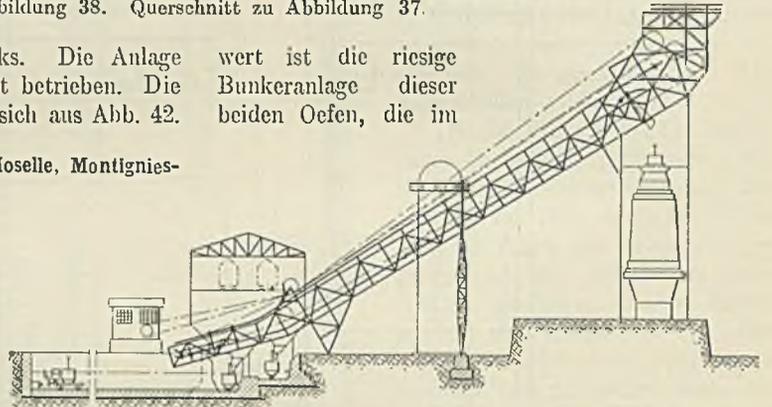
Schrägaufzug der Usines Gustavo Böil, La Louvière.
